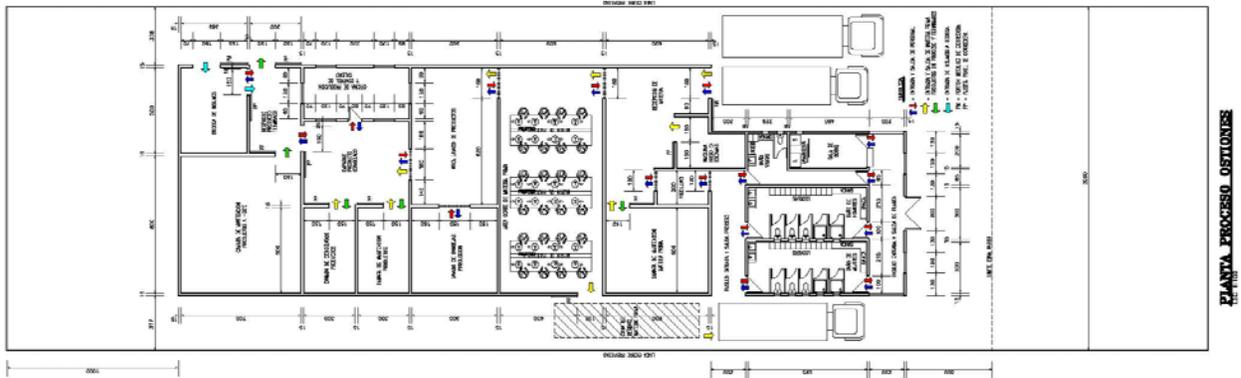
Propuesta de *layout* de la planta de proceso para la Coop-M31.
